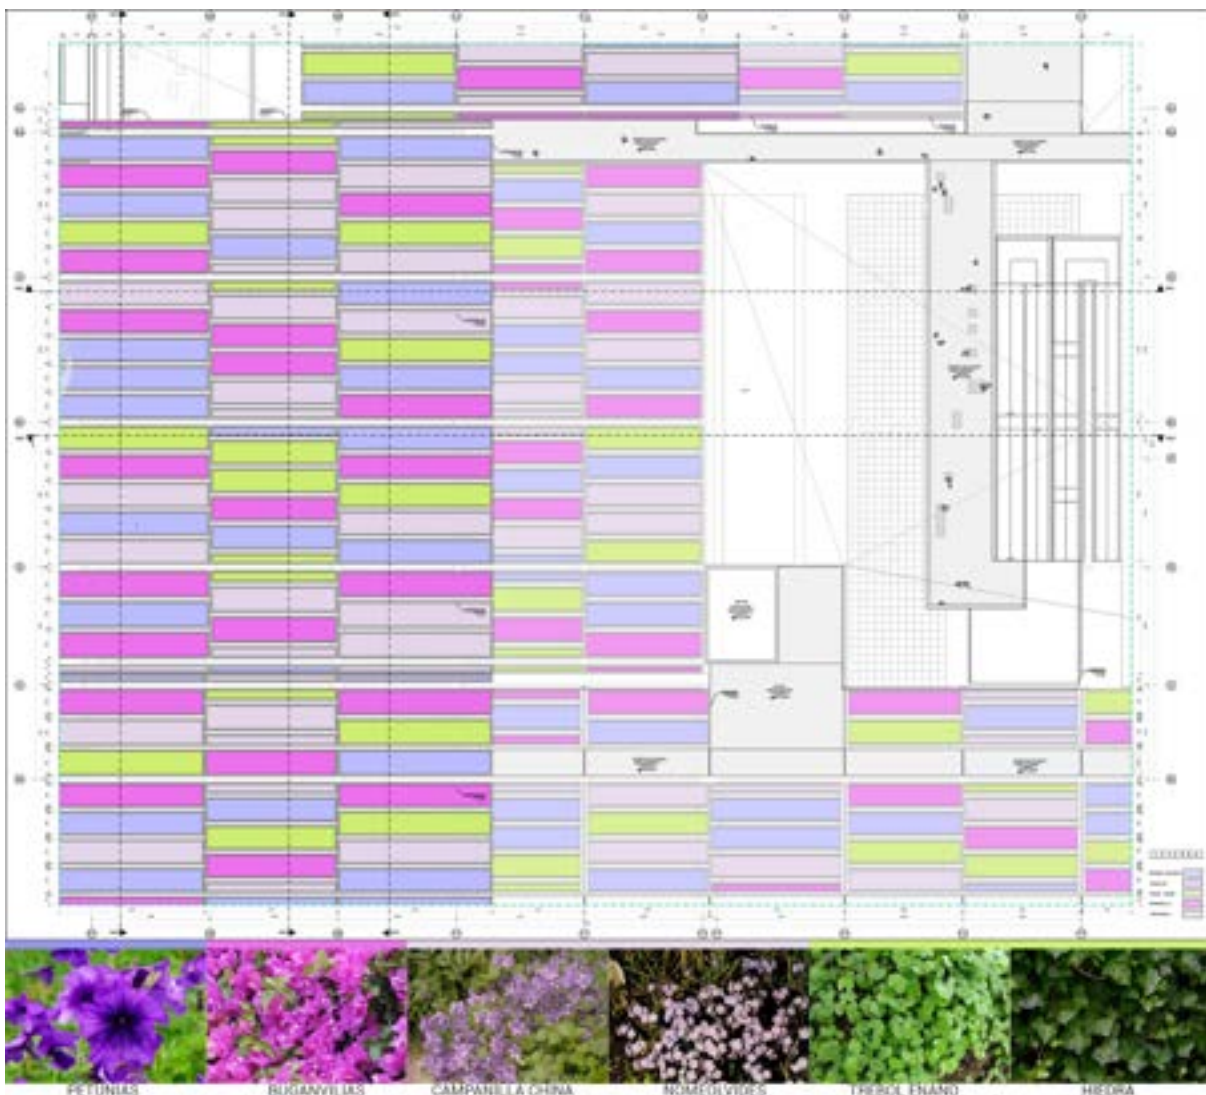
Planta de techos con cuadro resumen de vegetación utilizada.
